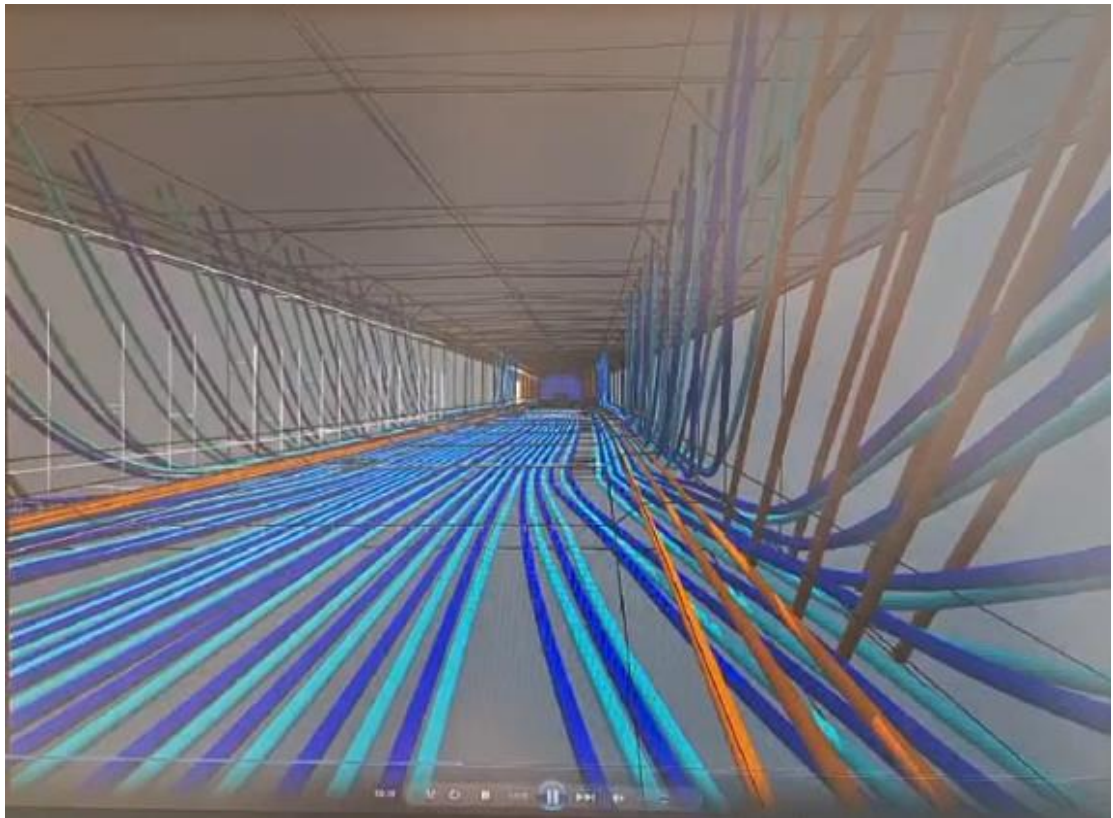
Фрагмент фактичного армування прогонової будови моста попередньо напруженою арматурою
